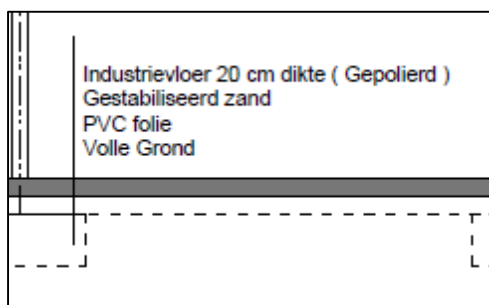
detail uit het doorsnede plan deel winkelruimte zoals aangereikt met aanduiding van de diepte van de funderingszolen en opbouw van de vloer
